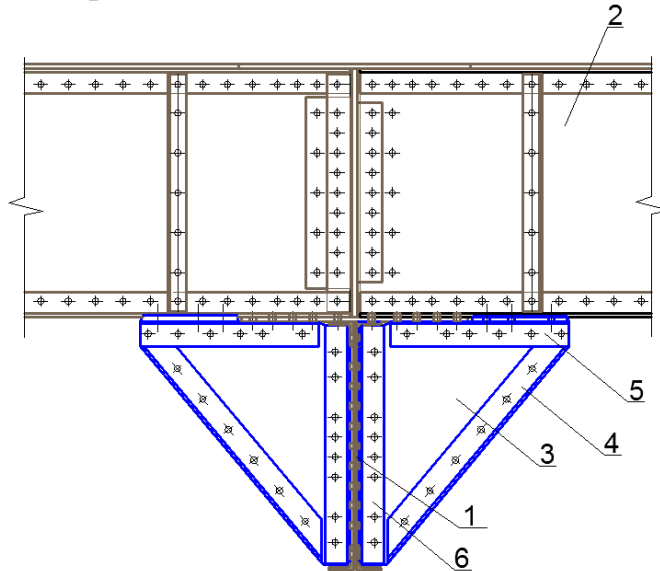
Вузол спирання поздовжньої балки на поперечну:
